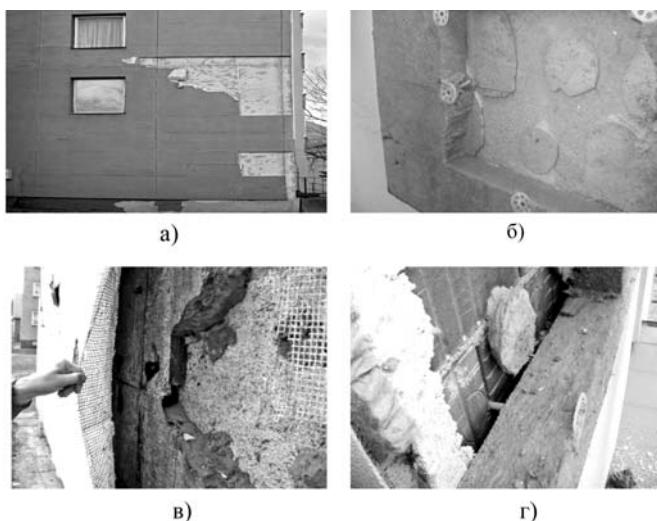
Фрагменты разрушенной теплоизоляции» на фасадах жилых зданий, утепленных минераловатными плитами
